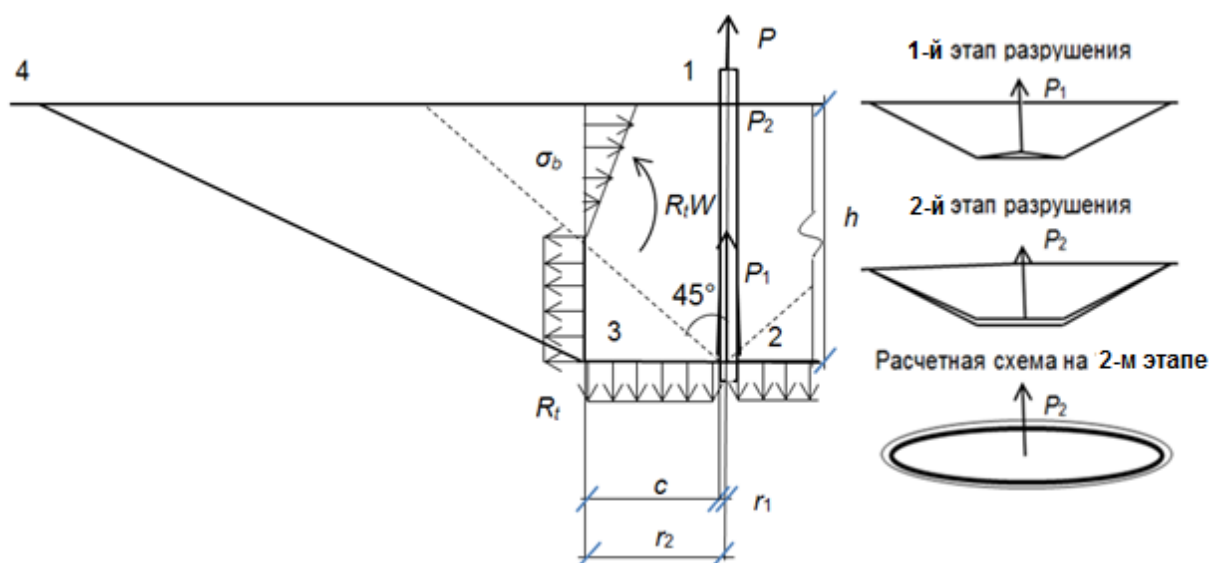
Схема усилий при разрушении бетона методом отрыва со скалыванием
